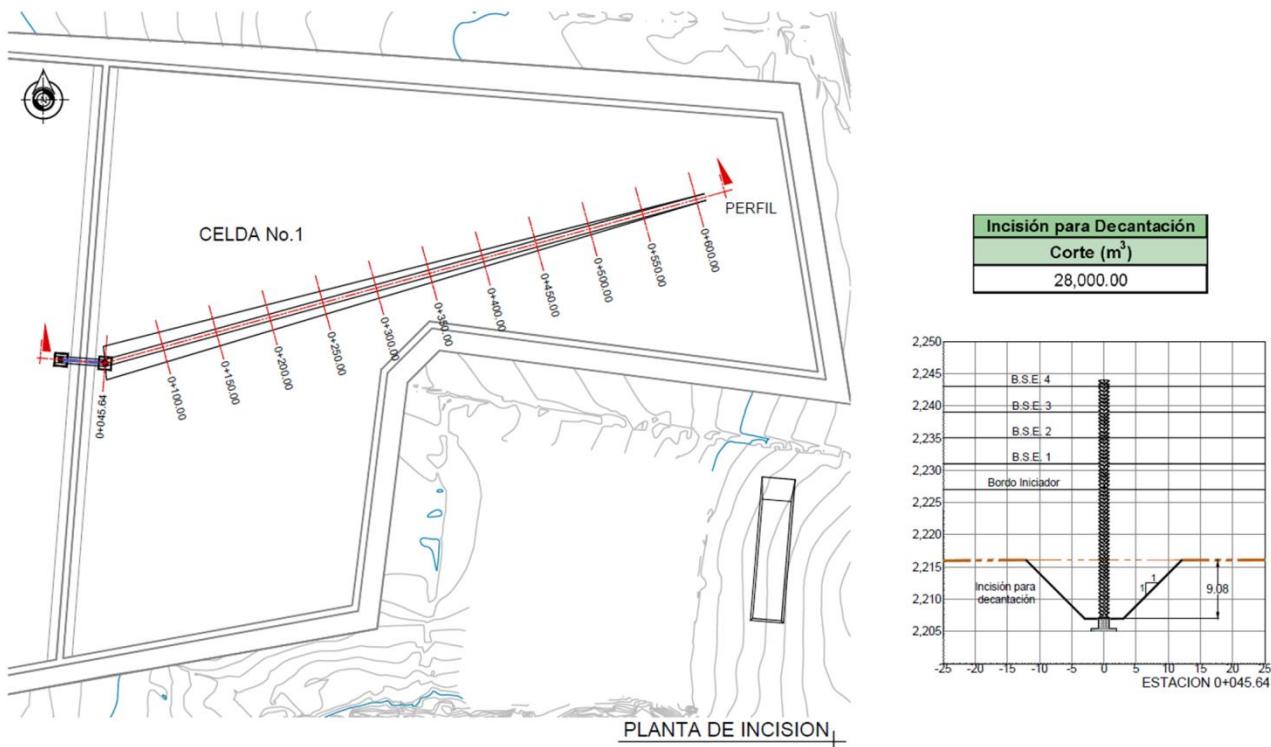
Planta incisión y perfil en sitio donde se localiza la torre de decantación
